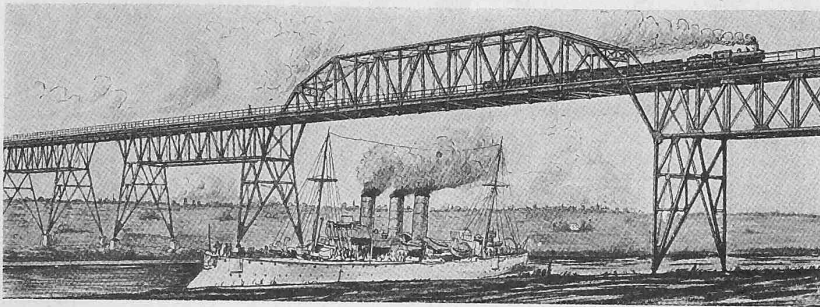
Eisenbahnbrücke bei Hochdonn (noch im Bau).
